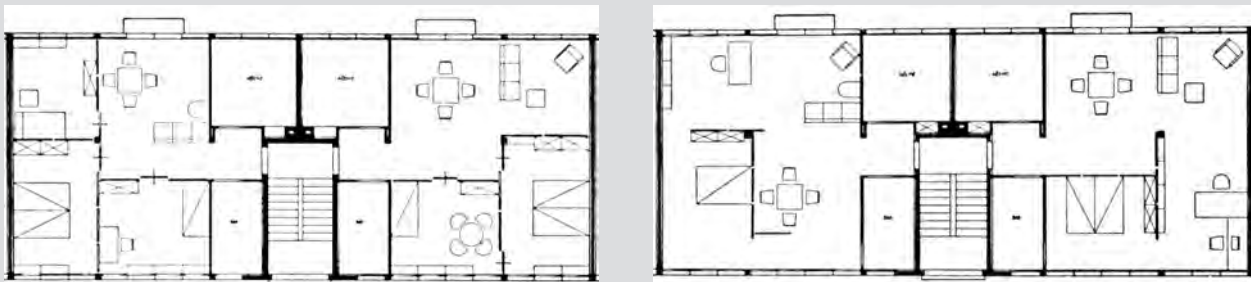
Mies van der Rohe: Wohnriegel am Weissenhof, Stuttgart 1927, Grundrissausschnitt des Wohnriegels mit alternativen Grundrissaufteilungen der Wohnungen Nr. 10 und Nr. 12
